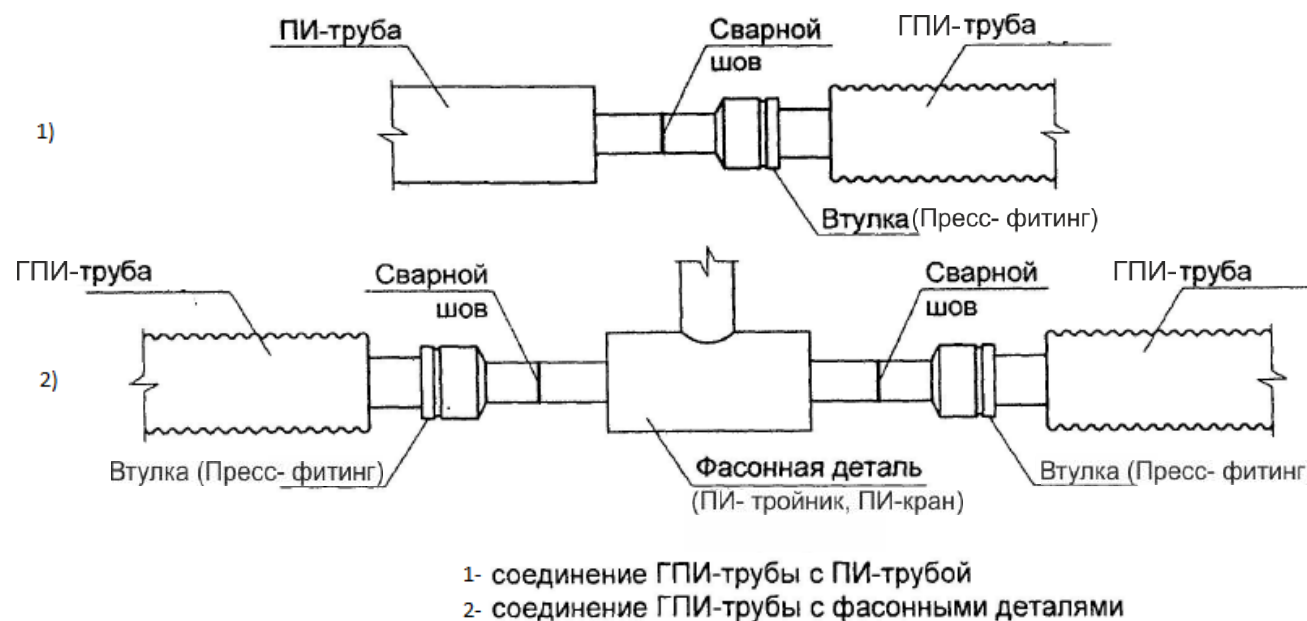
Варианты соединения ГПИ-труб с установкой втулки(пресс-фитинга)
